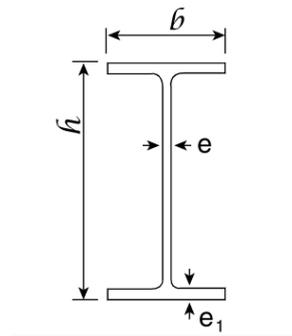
Perfil IPE 220 (h 22 x b 11)
